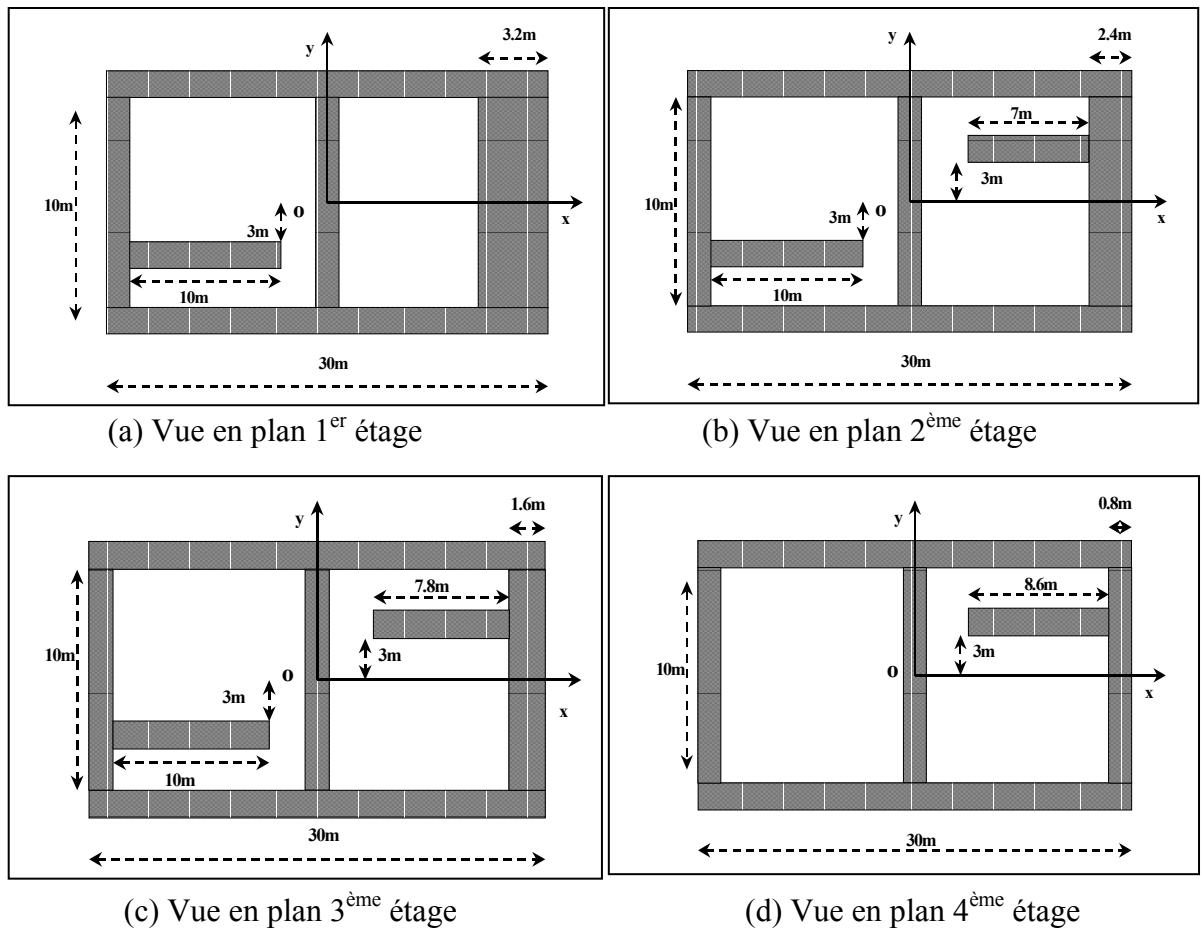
Vue en plan du Bâtiment EDF [1]
